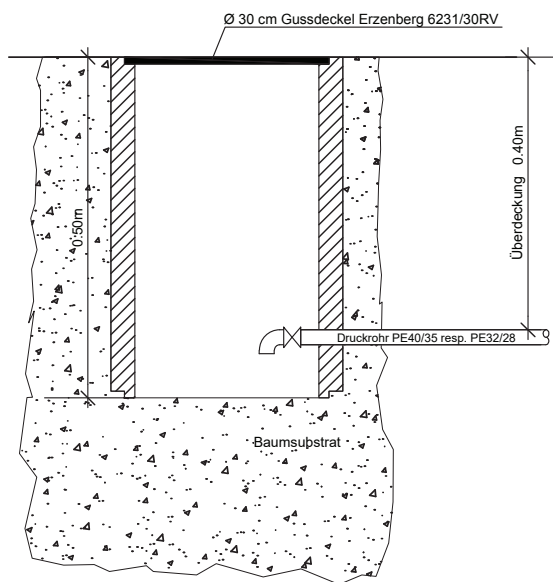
Detail Entleerungsschacht innerhalb Baumrabatte
